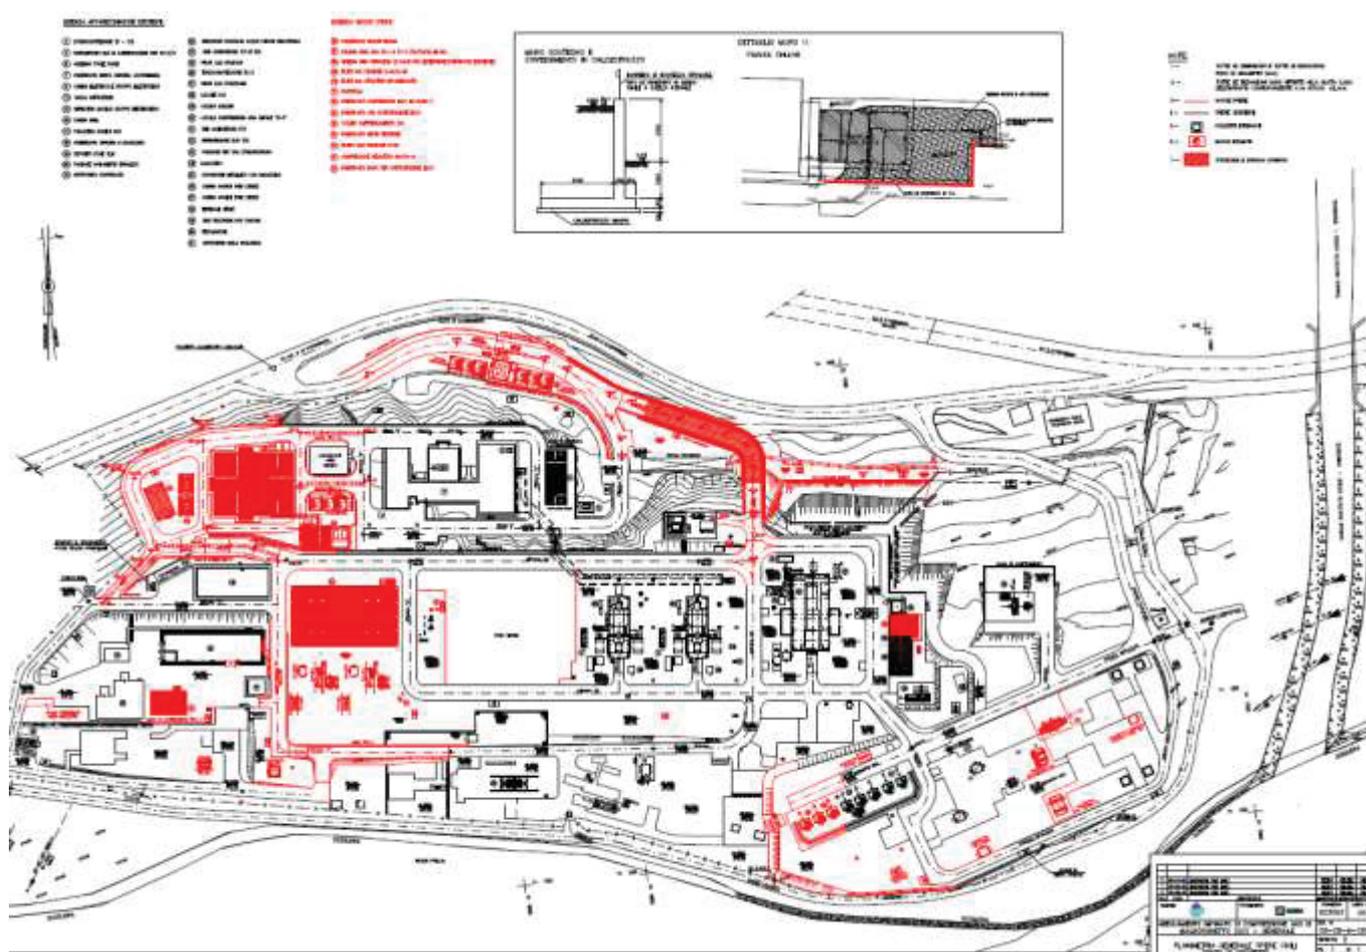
Stralcio "Planimetria opere civili stato di progetto" doc. 00-CB-A-12012
